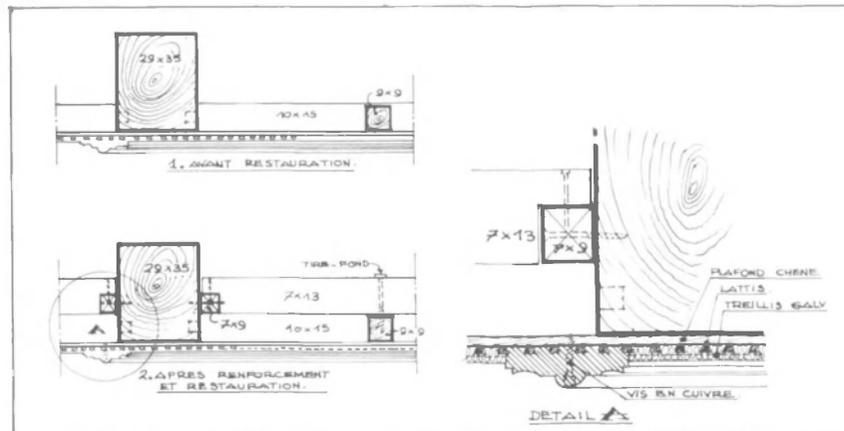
Détails du support du plafond avant et après renforcement et restauration
